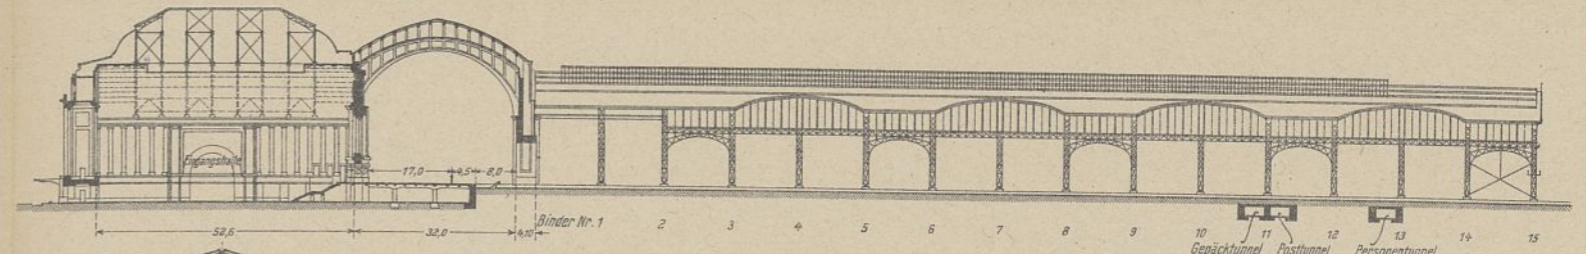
Längsschnitt durch die Eingangshalle und entlang der Wand B. 1:1500.
